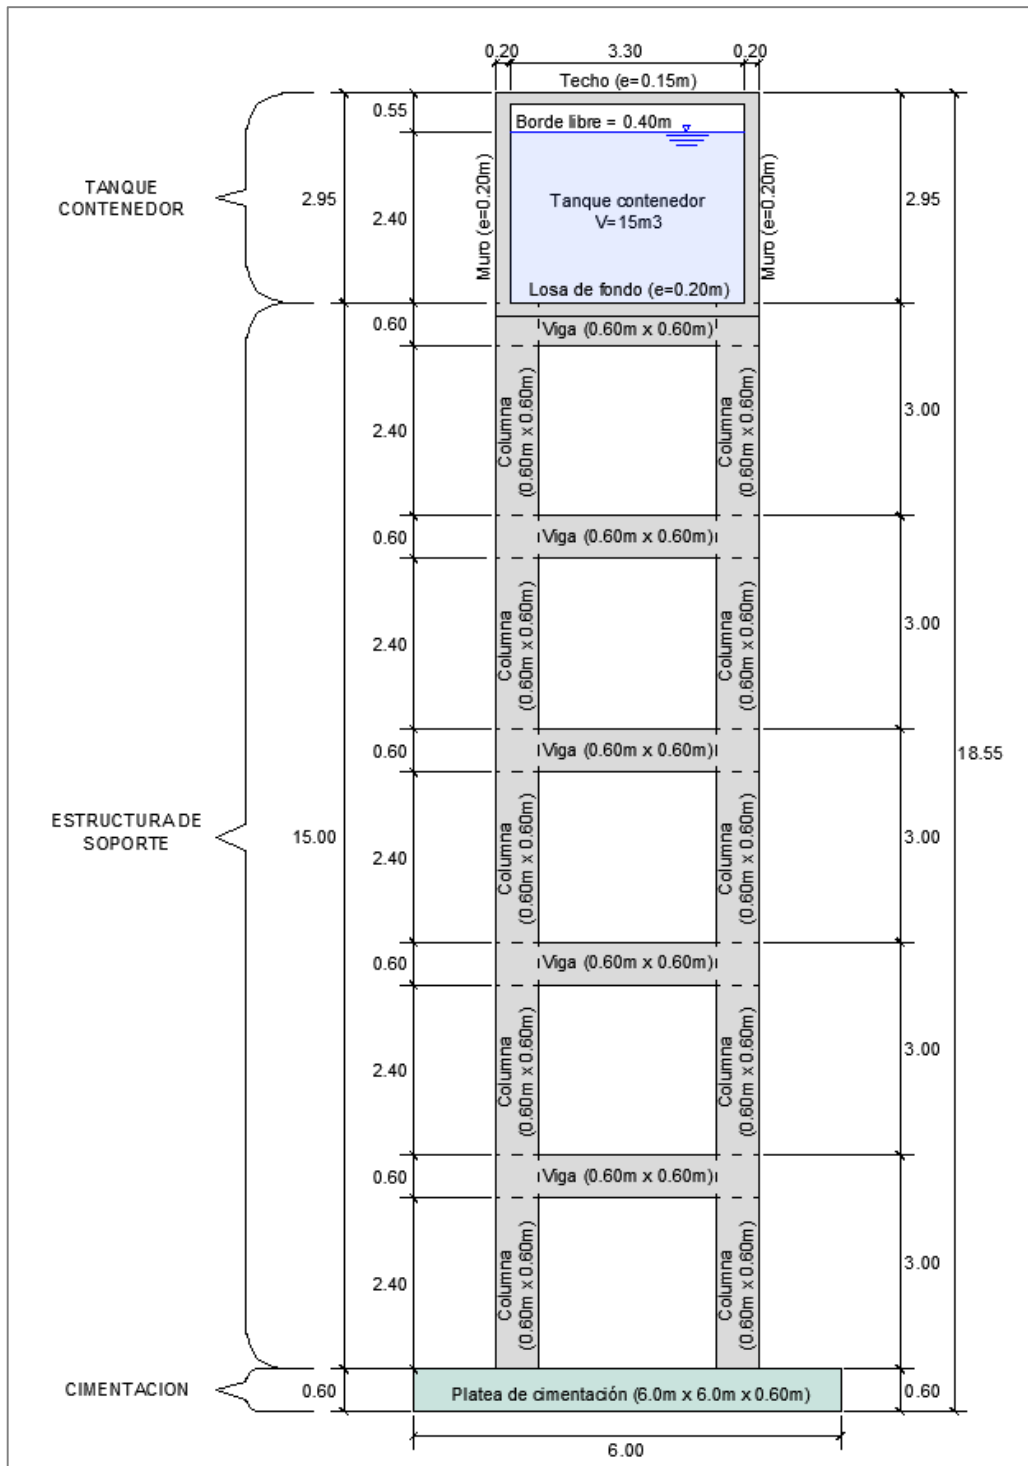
Vista en elevación de la configuración estructural del reservorio elevado 25m³
